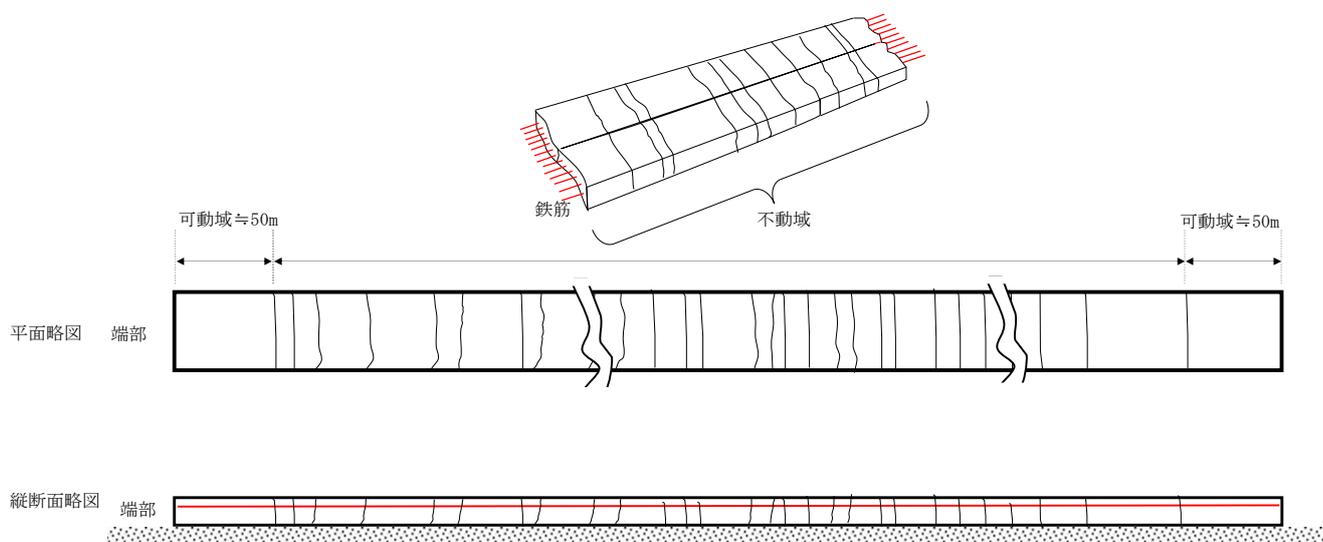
CRCP のひび割れ発生のイメージ
